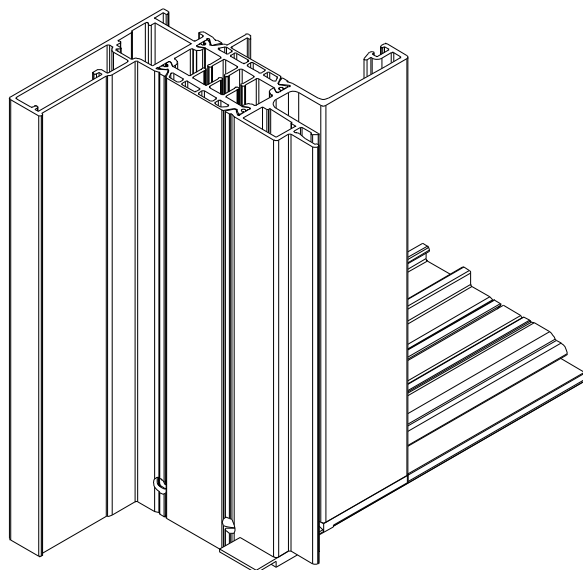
DETAILS D'ASSEMBLAGE DORMANT EN PARTIE BASSE
